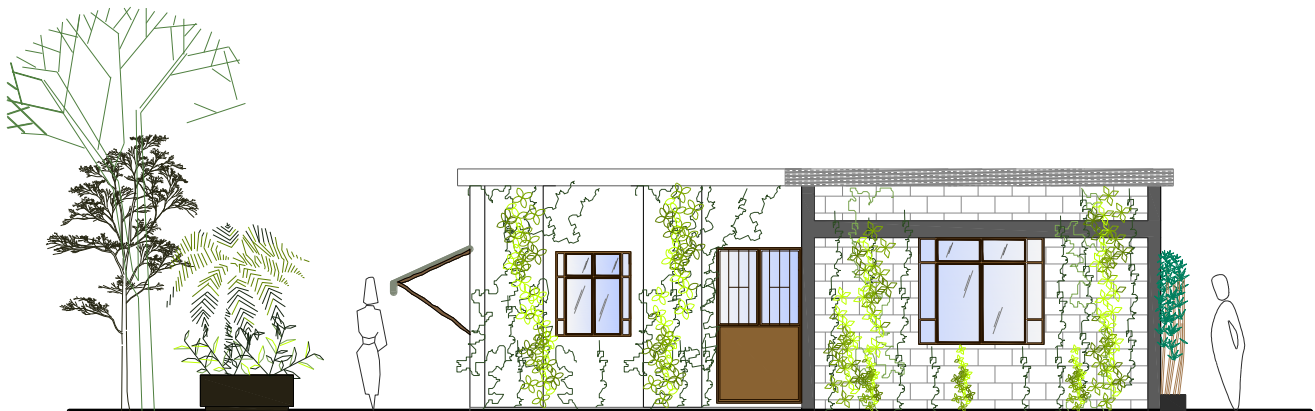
Diseño aplicativo de la Fachada Este. Fuente: Elaboración propia.
